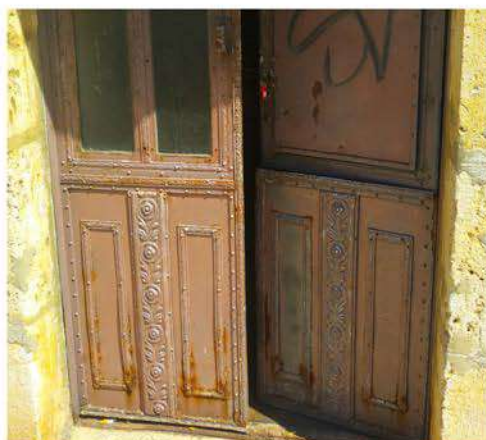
Imagen de la puerta metálica de entrada, con muestras de oxidación Fuente: Foto propia
